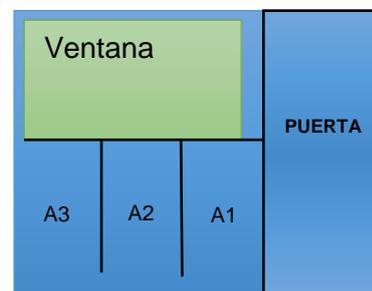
Muro este – adherencia - 3 paños de 0,59 m x 1,02 m
